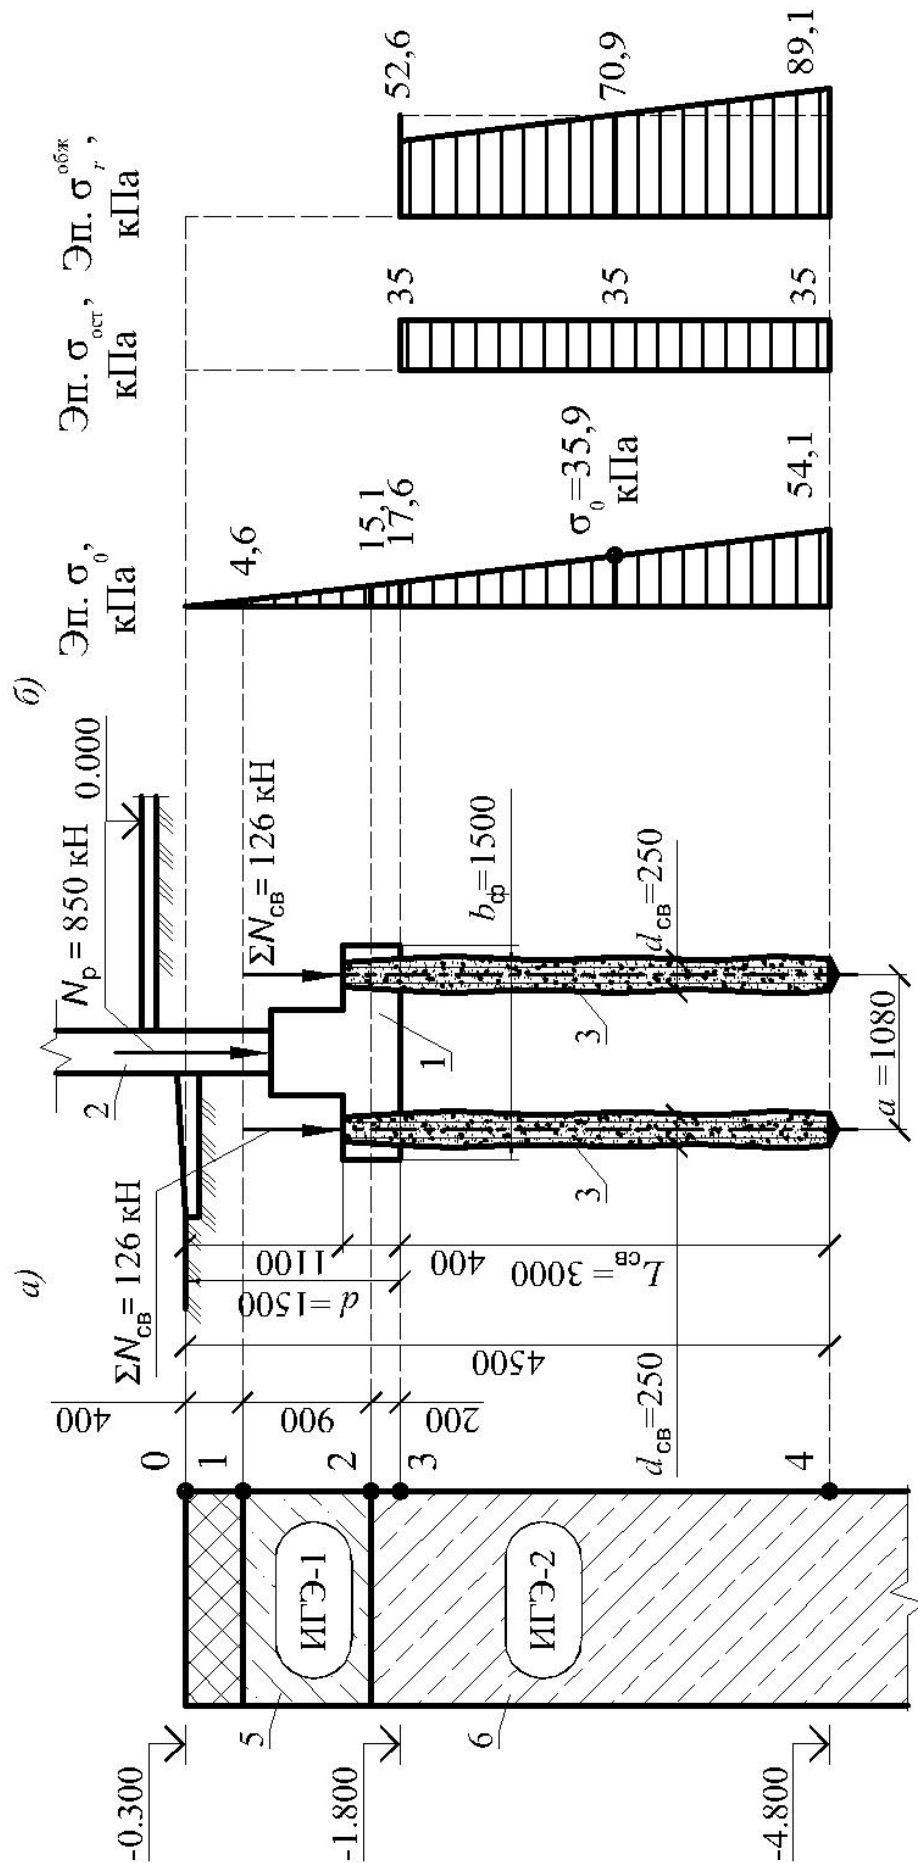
Расчетная схема усиленного отдельного фундамента реконструируемого здания (а) и эпюры напряжений в грунте основания (б):
